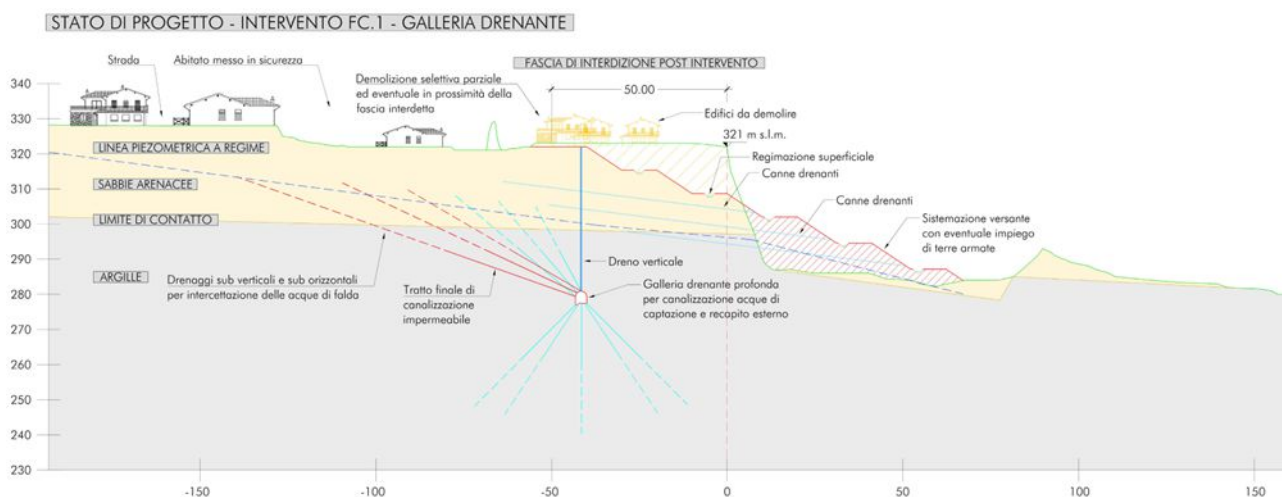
Sezione tipologica del versante in frana con galleria drenante profonda nelle argille.
